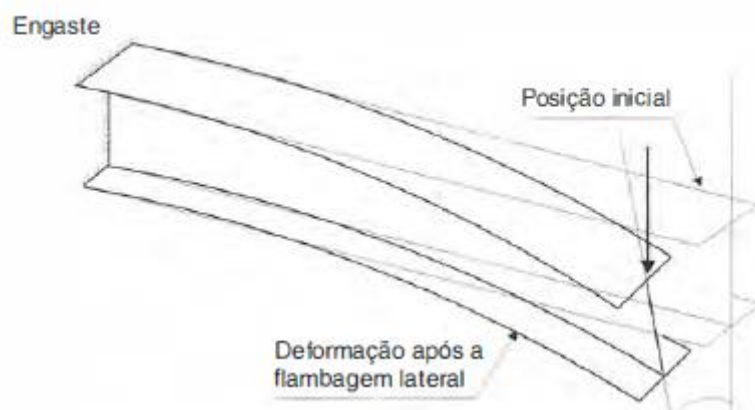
Flambagem lateral em vigas. (Fonte: Pfeil, 2008.)
